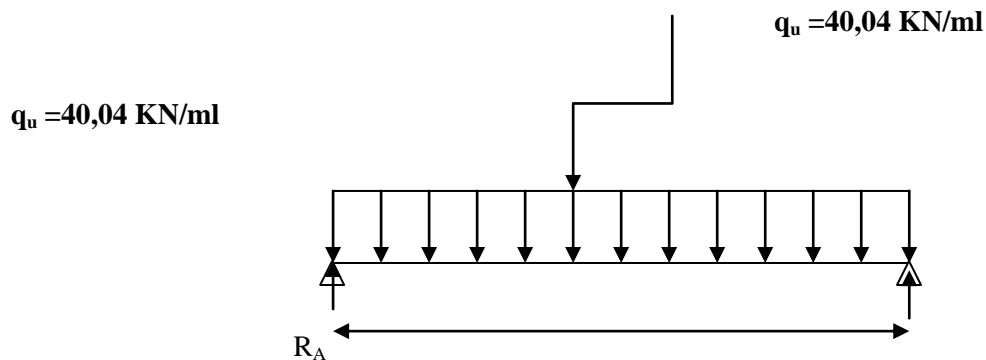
Schéma statique de la poutre palière.' ELU.
